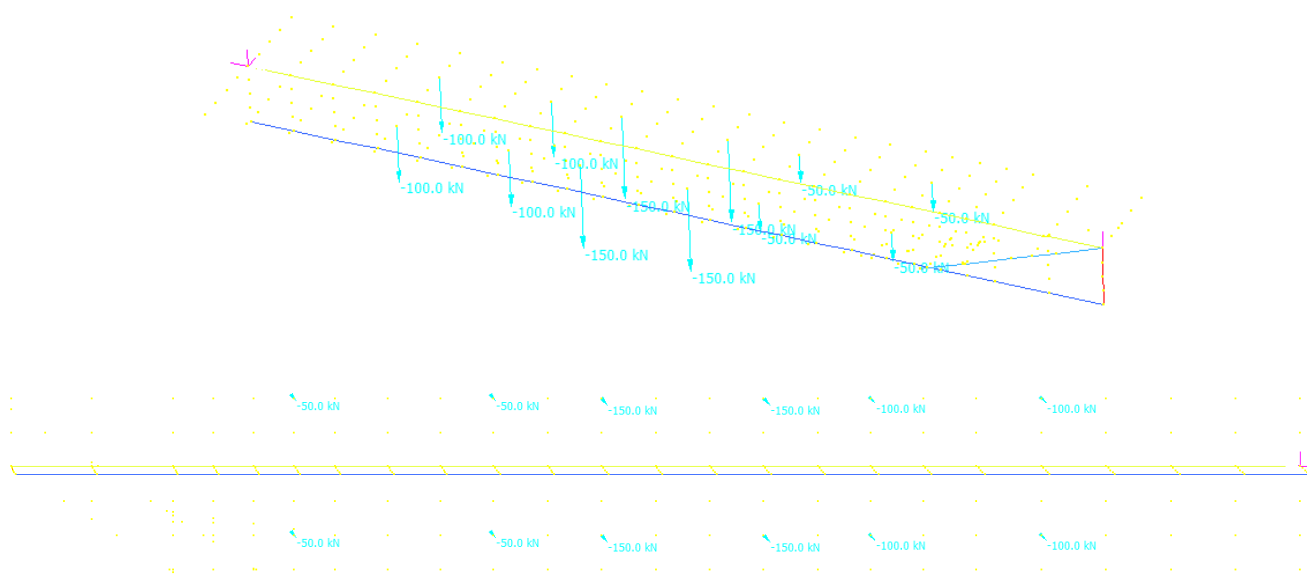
Modello tridimensionale del traverso tipico isolato. Vista 3D e planimetria della disposizione dei carichi
